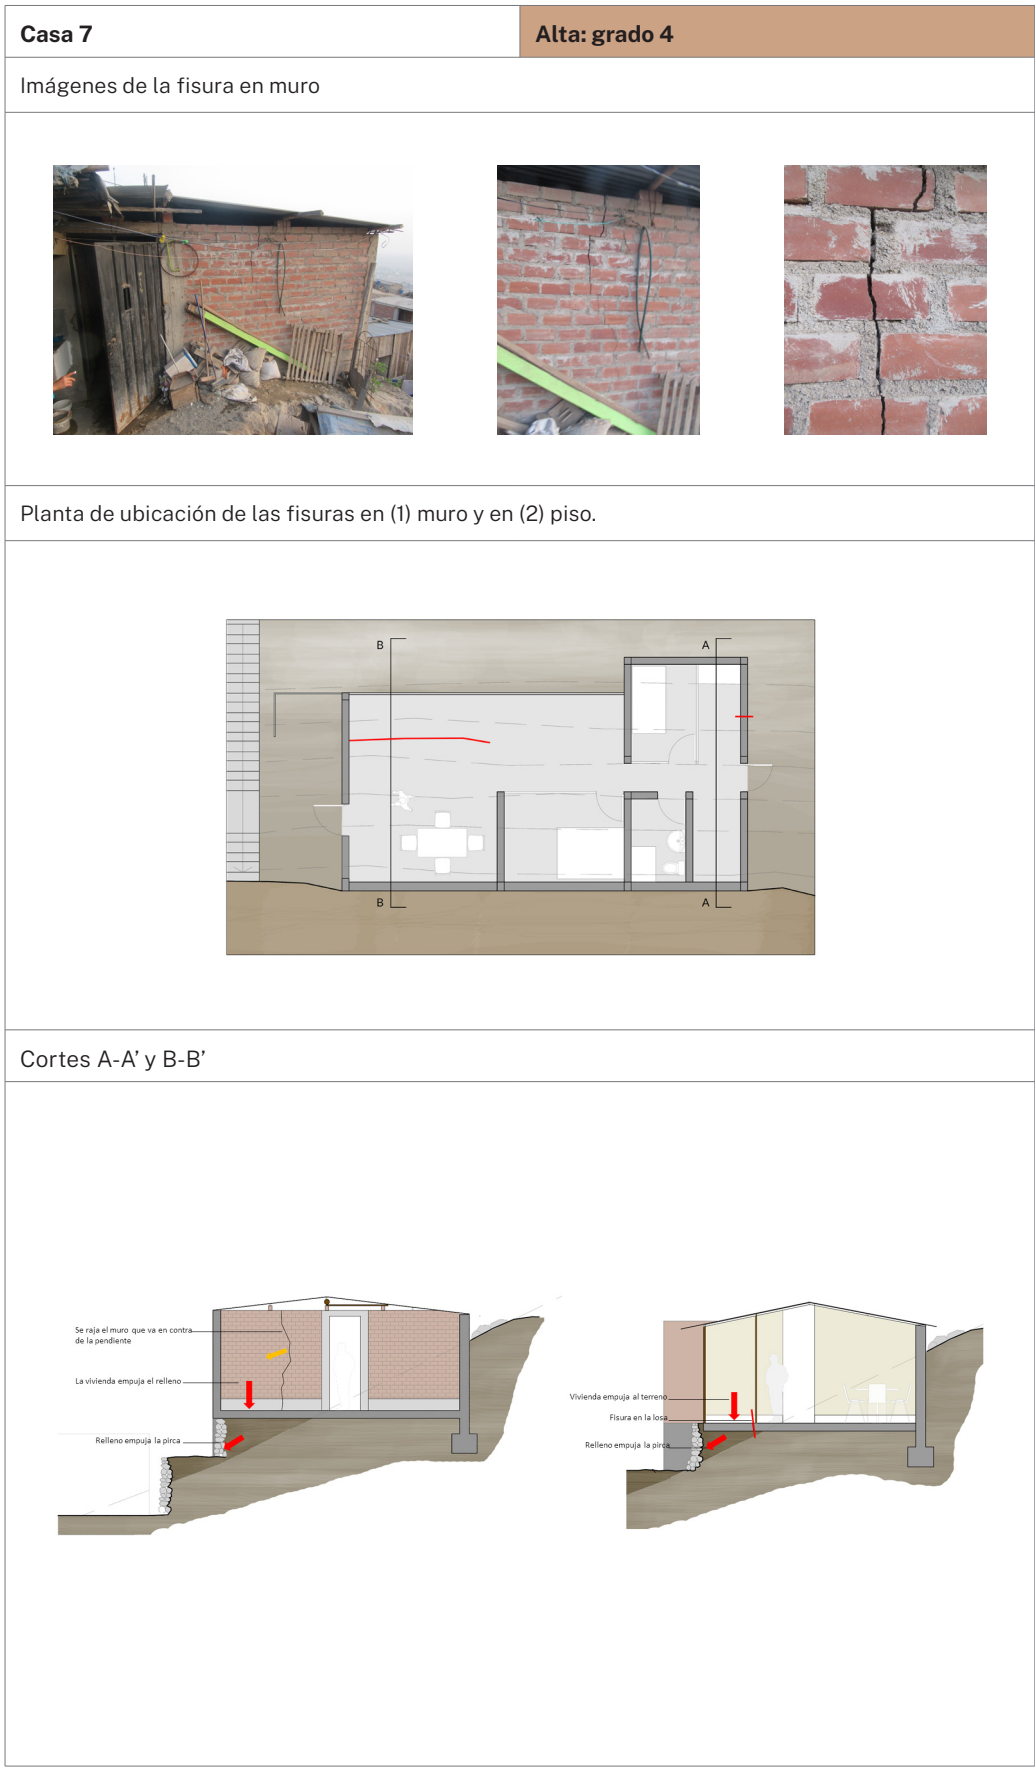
Fisuras en muros y pisos de la casa 7, en imágenes, plantas y cortes. Elaboración propia, 2017.
